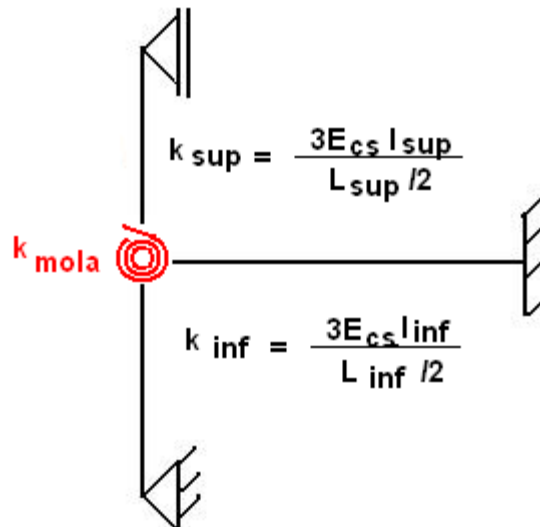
Rigidez da mola: metade do pilar para cima e metade do pilar para baixo
